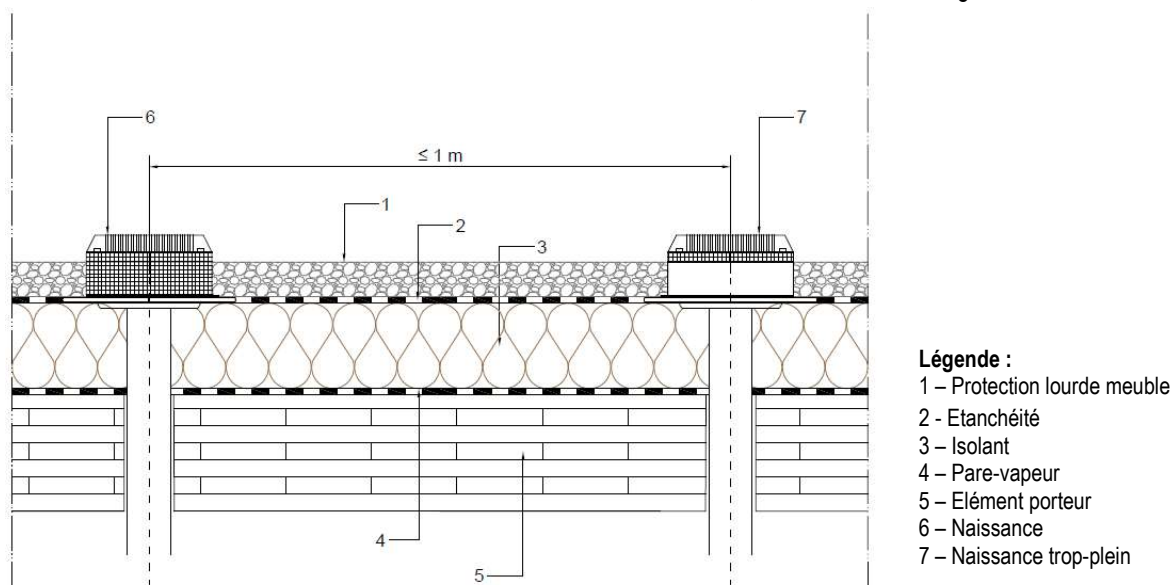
CLT - Mise en place d'un Réseau Secondaire sur toiture-terrasse étanchée avec protection lourde meuble
